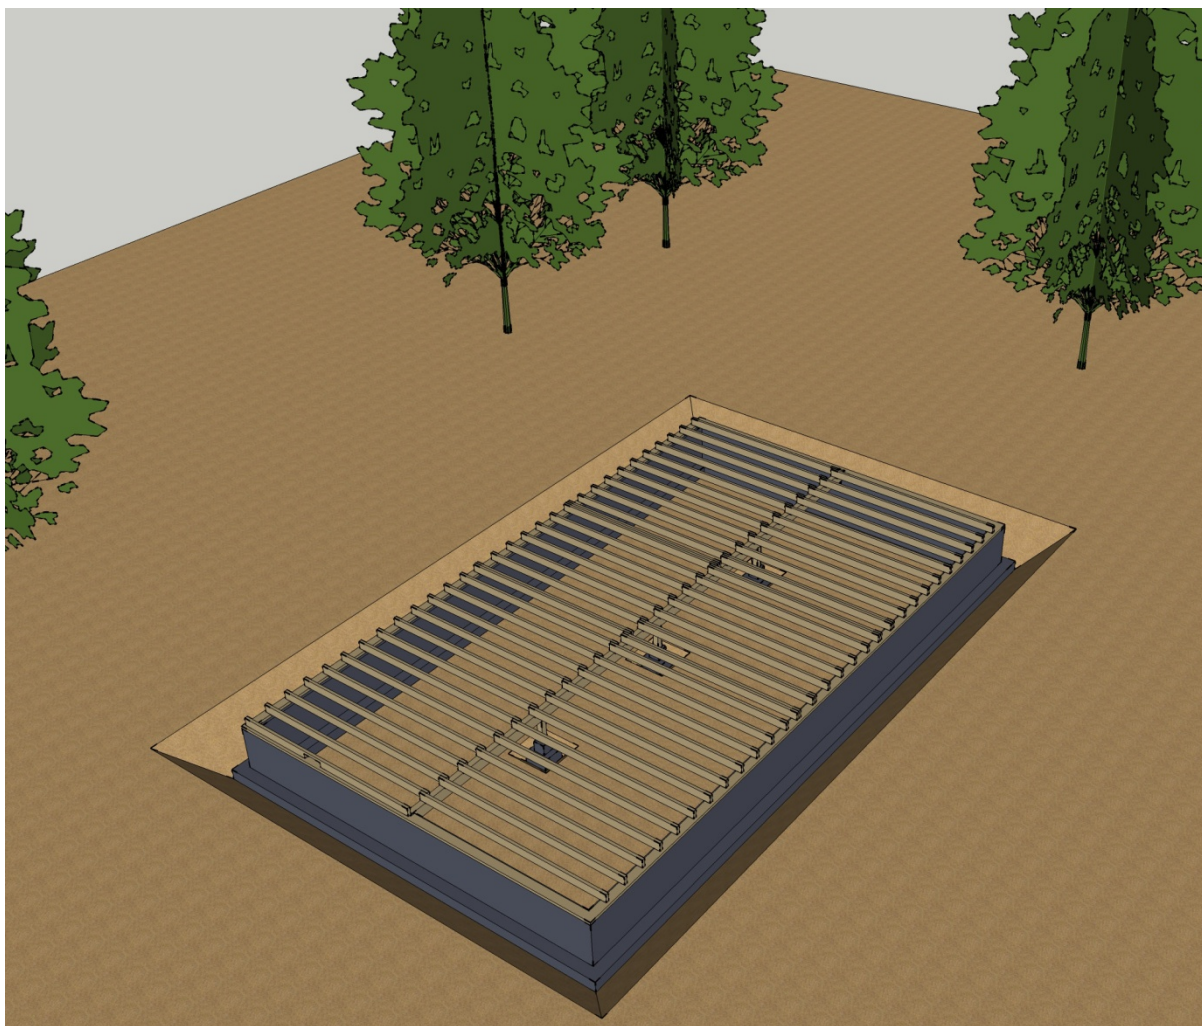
Montagem das vigotas de pavimento. As entregas das vigotas são desfazadas sobre a viga para aumentar a área de contacto na entrega. A ligação entre vigotas é feita com pregagem de face.
